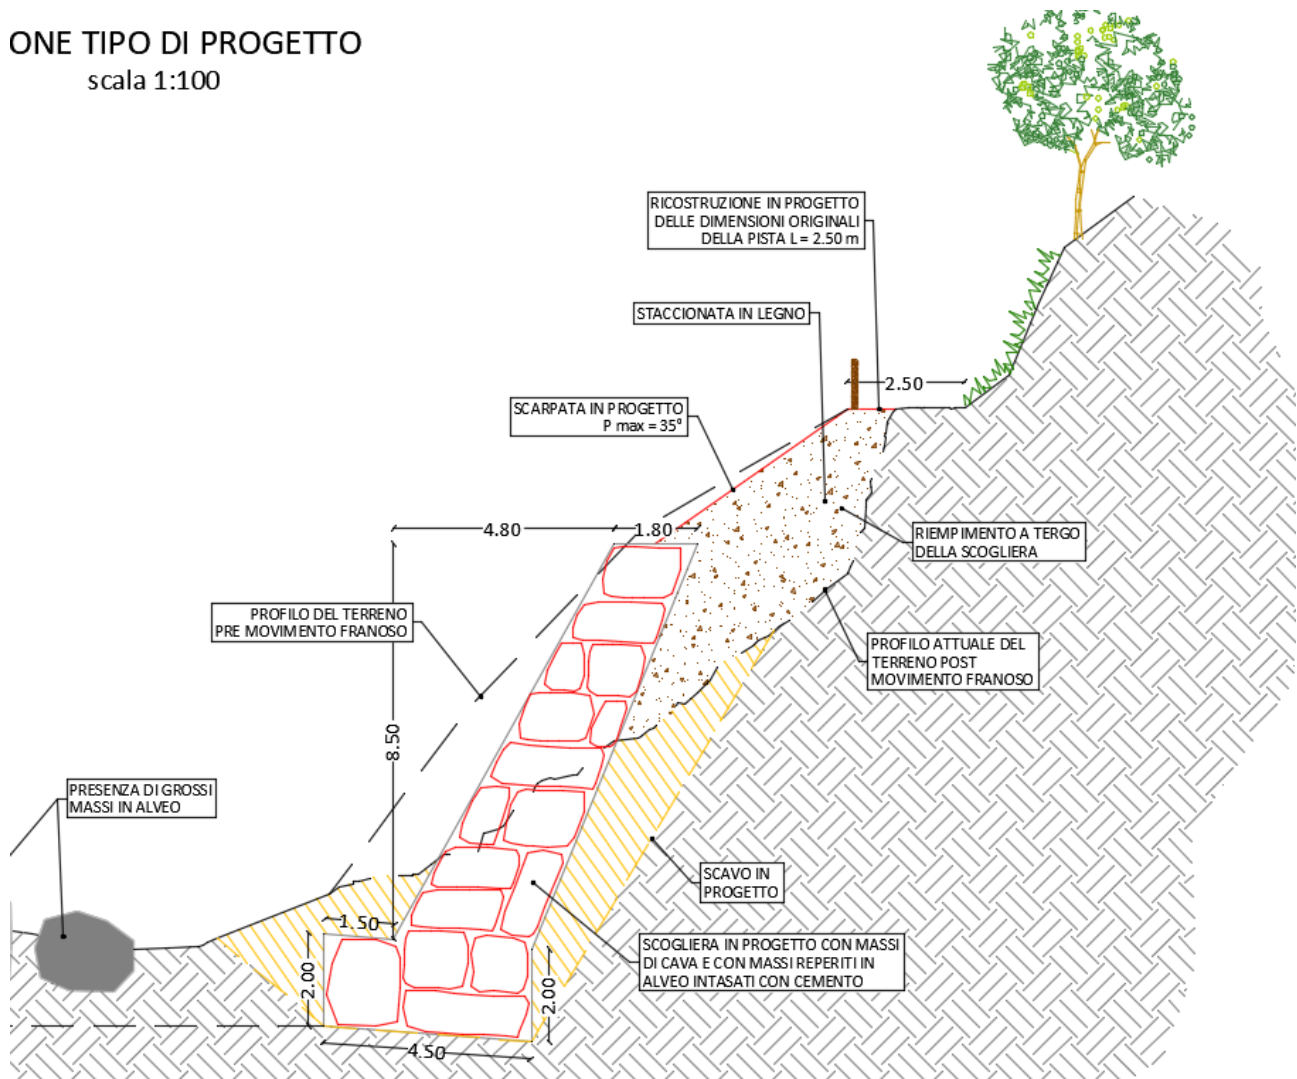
Estratto della Tav.05\_Sezioni\_Progetto
